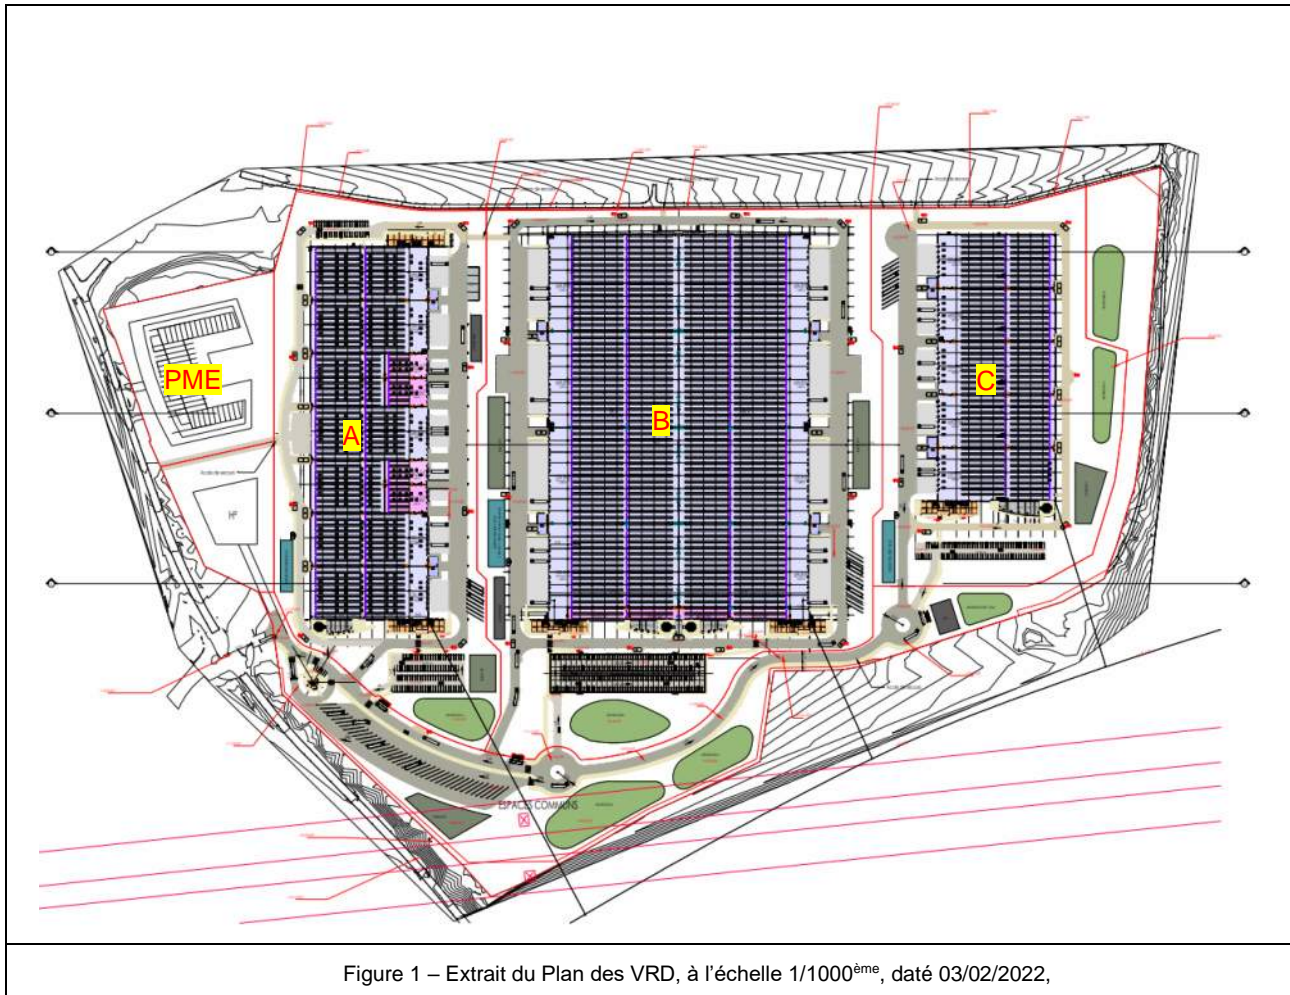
Extrait du Plan des VRD, à l'échelle 1/1000^{ème}, daté 03/02/2022,
